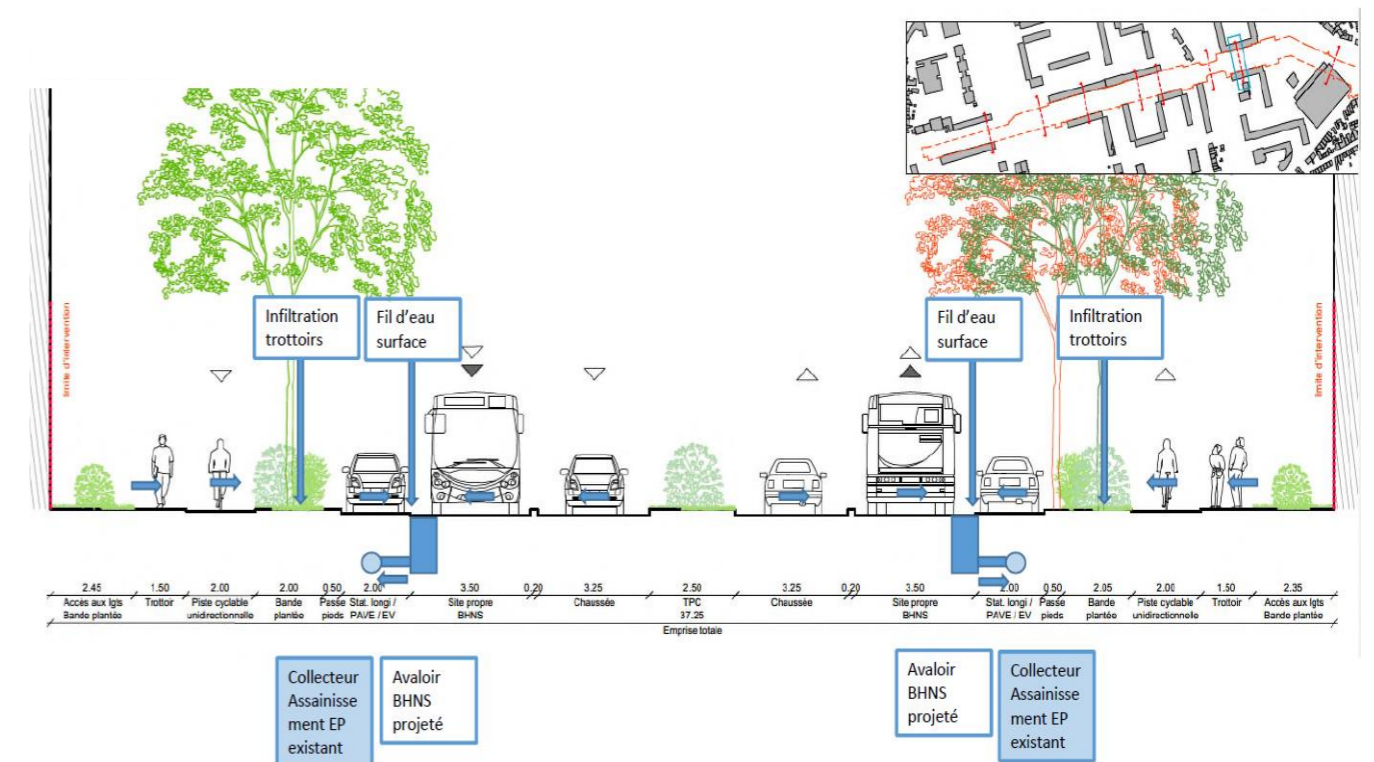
principes de drainage de la plateforme du BHNS sur l'avenue Charles De Gaulle
